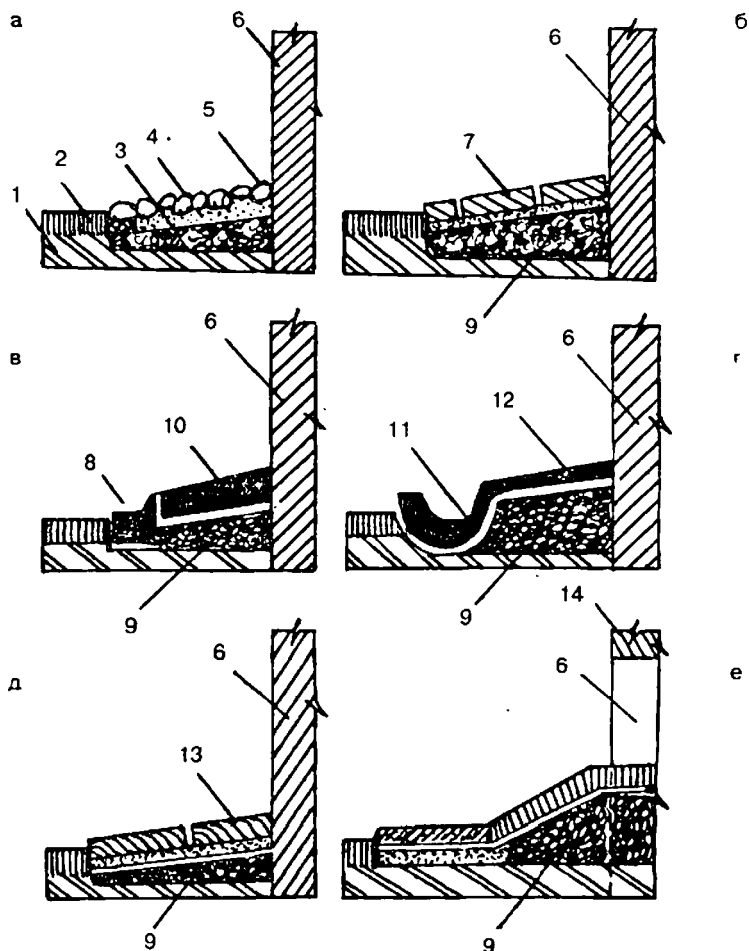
Отмостки (А - булыжная, Б - кирпичная, В - асфальтовая, Г - бетонная, Д - из бетонных плит, Е - грунтовая):
